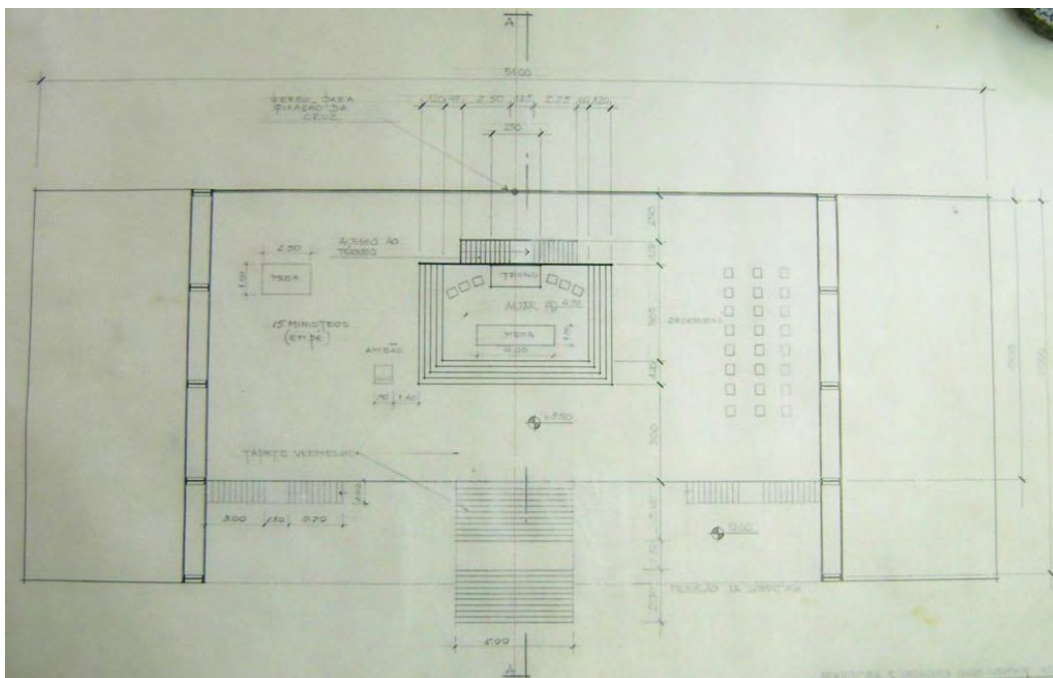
Planta Baixa nível 2,5m. Junho de 1991.
